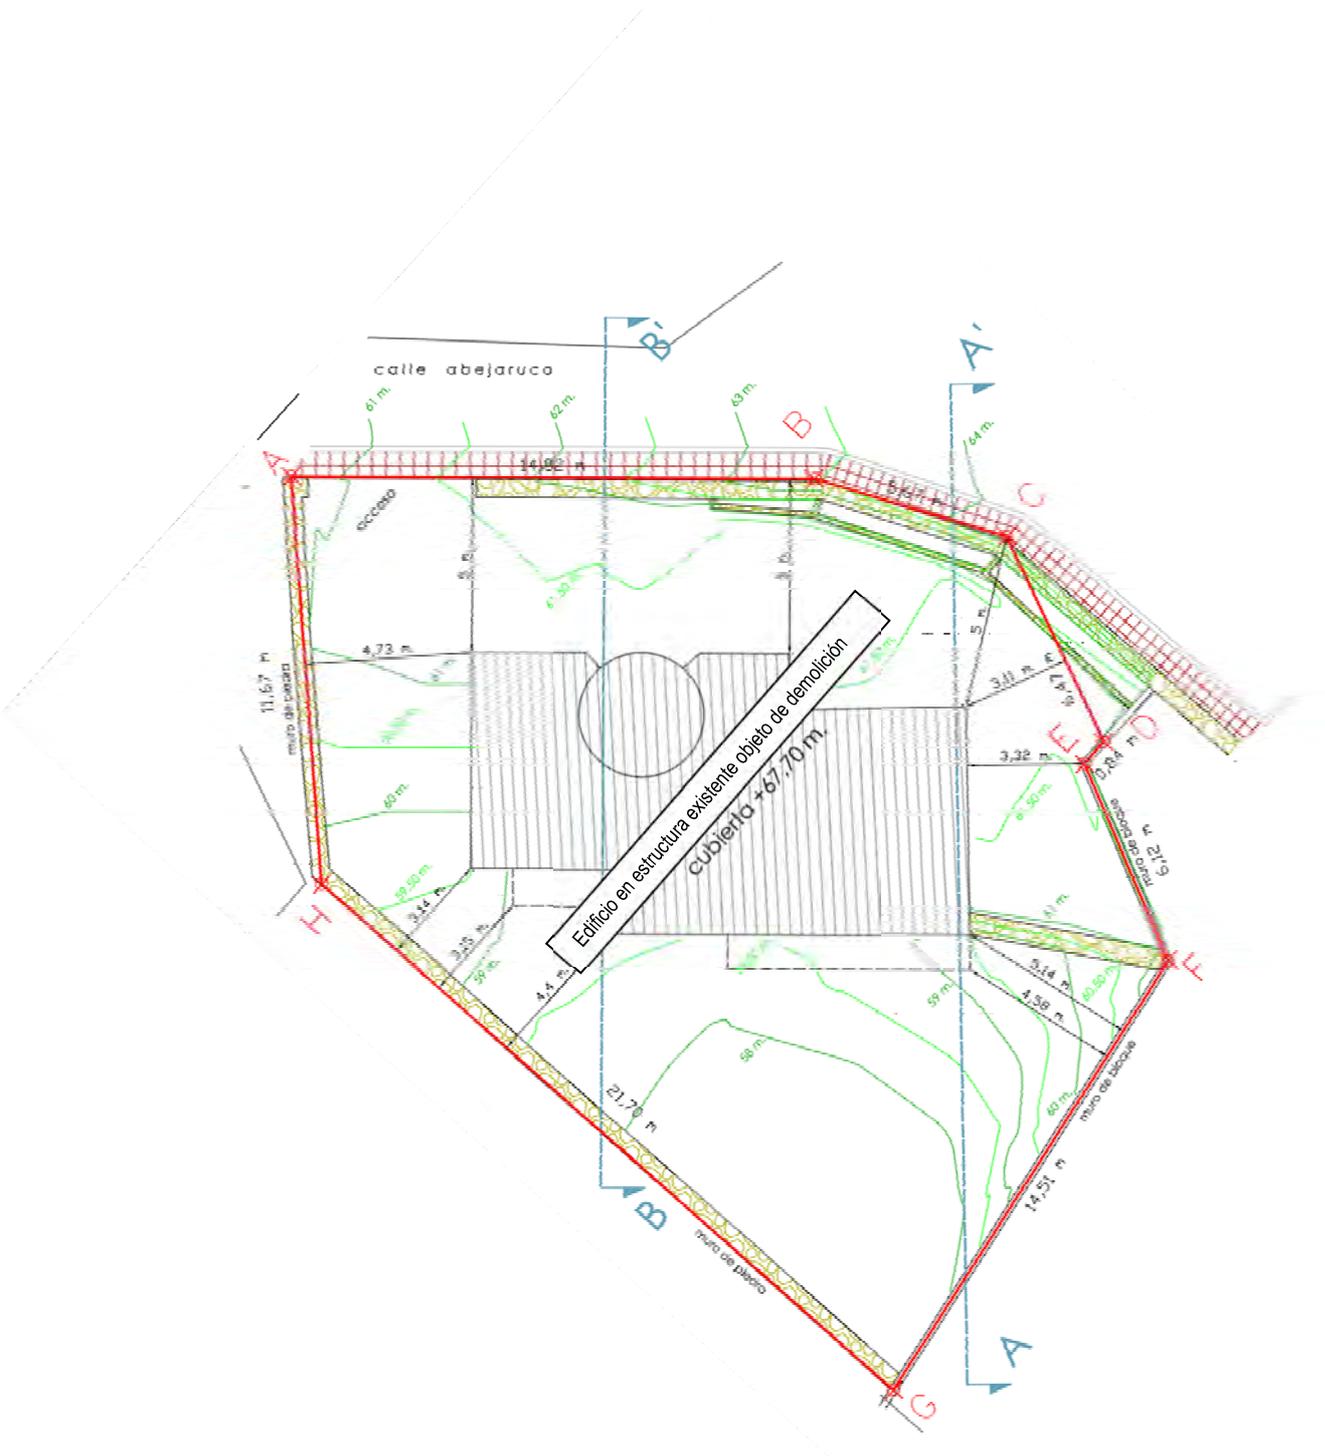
Levantamiento topográfico del estado actual de la parcela y del vial C/Papagayo
